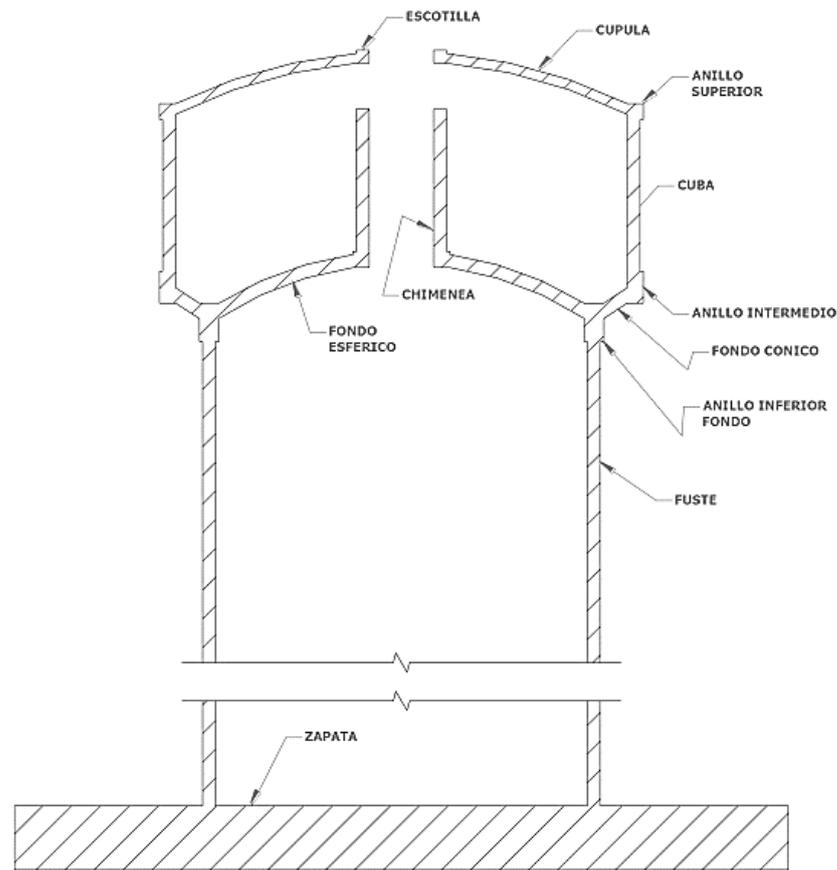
Partes o elementos estructurales de un reservorio elevado
